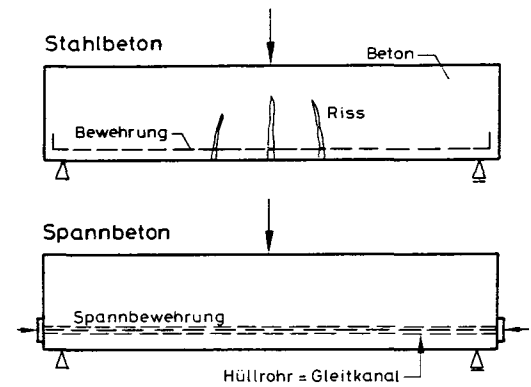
Verbundwerkstoffe Stahlbeton und Spannbeton mit nachträglichem Verbund
